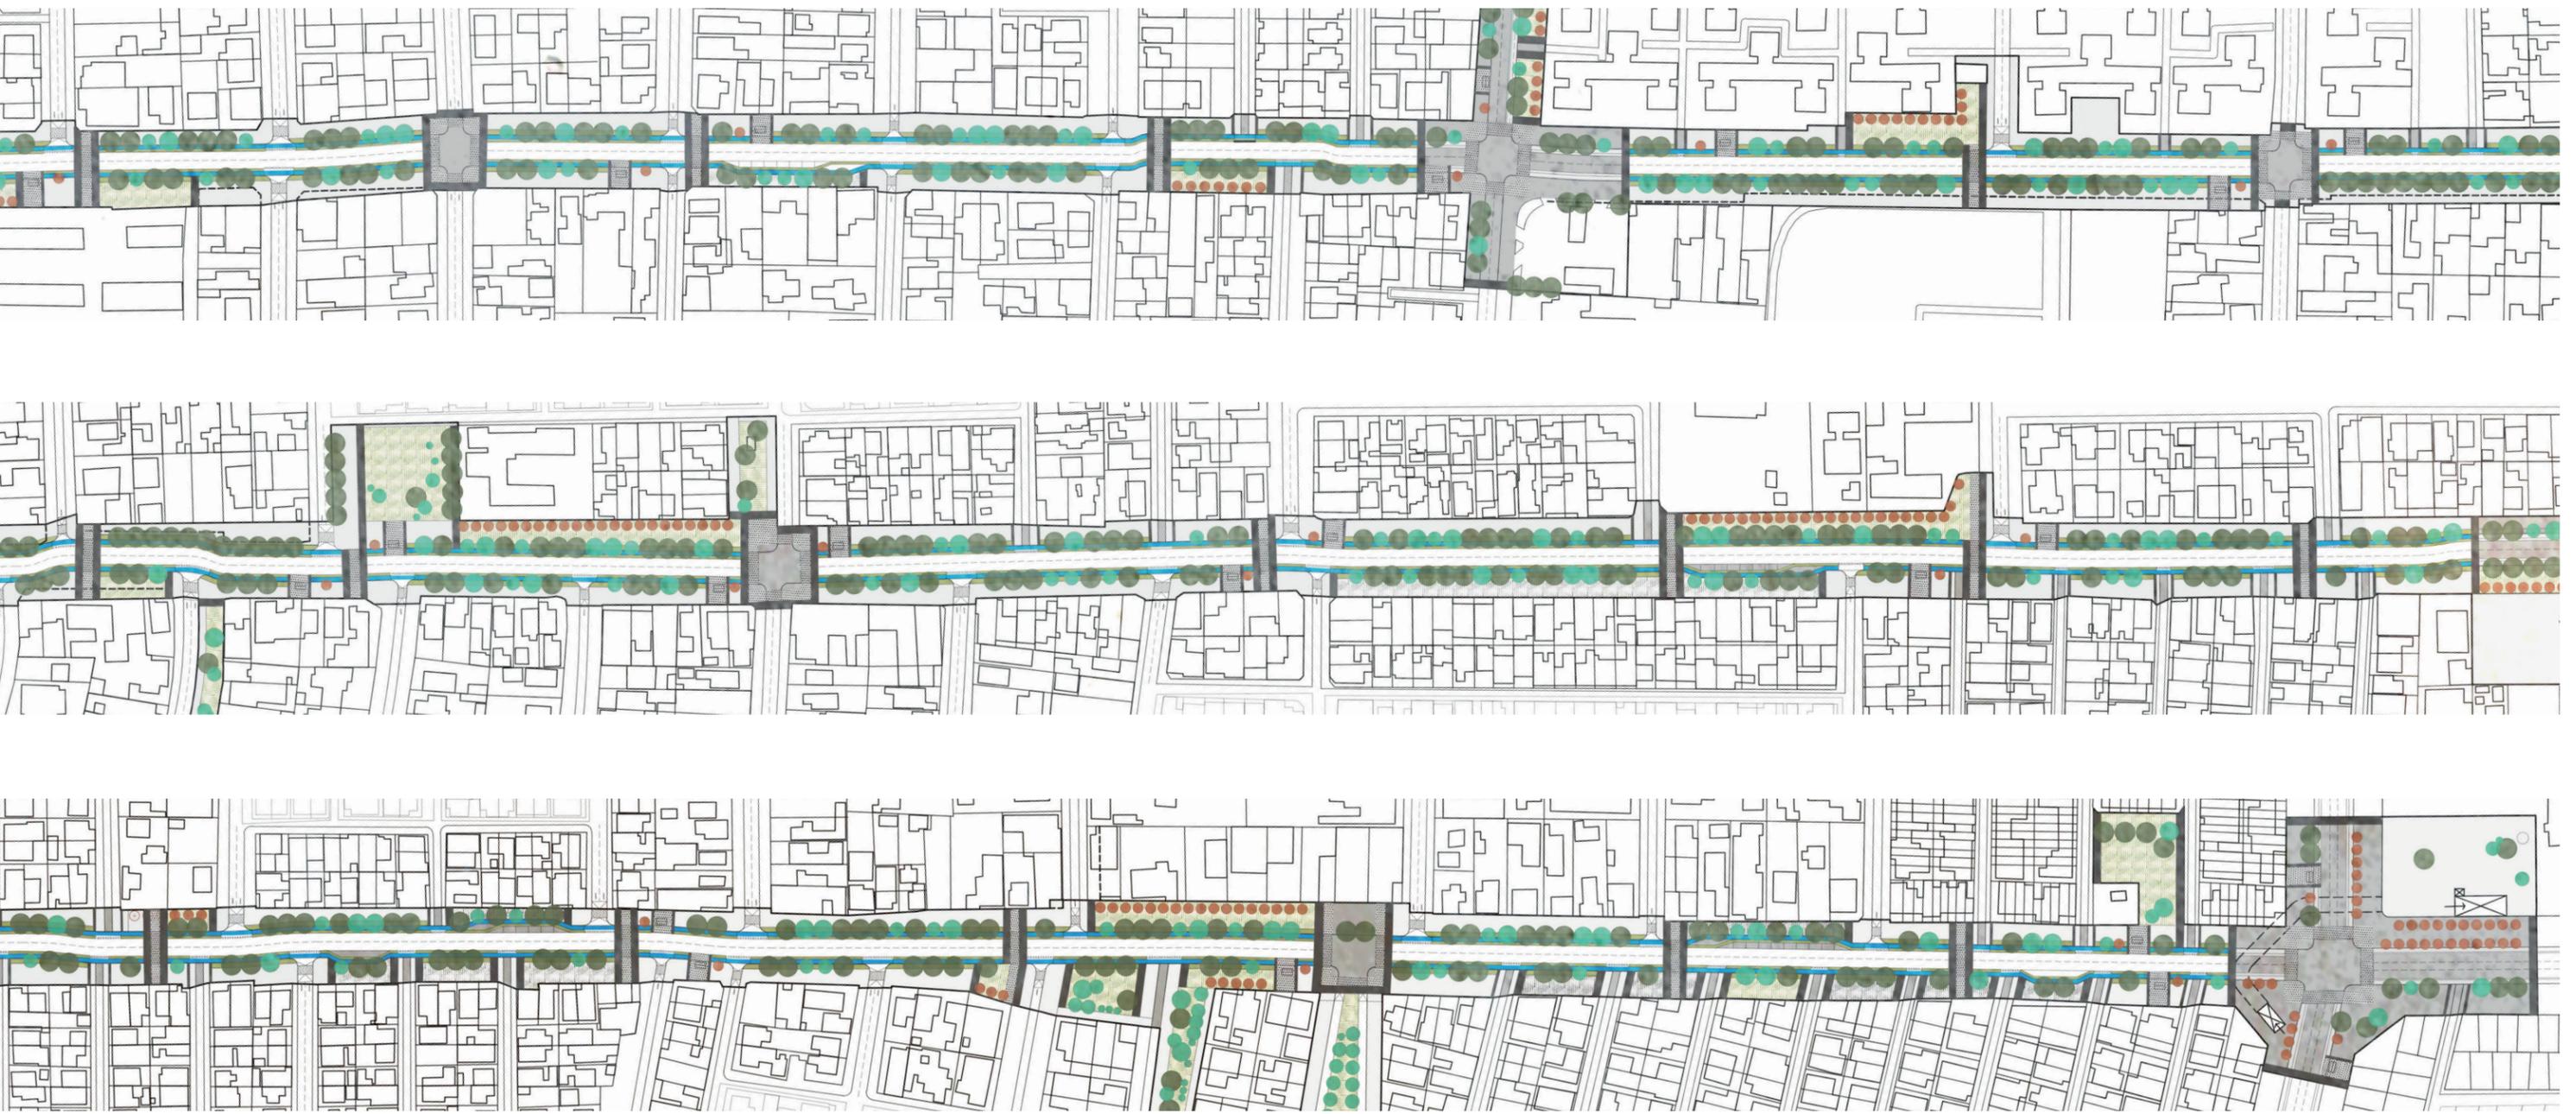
Planta general Nuevo Paseo Público Avenida Padre Hurtado (*propuesta sujeta a cambios)
